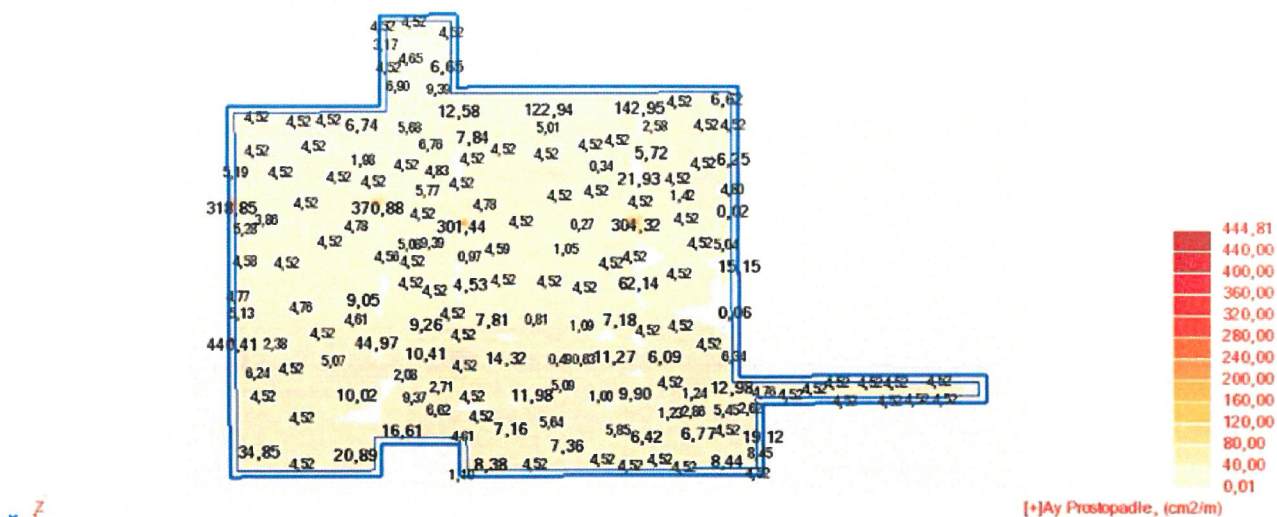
Wymagane zbrojenie dołem płyty fundamentowej w kierunku Y
